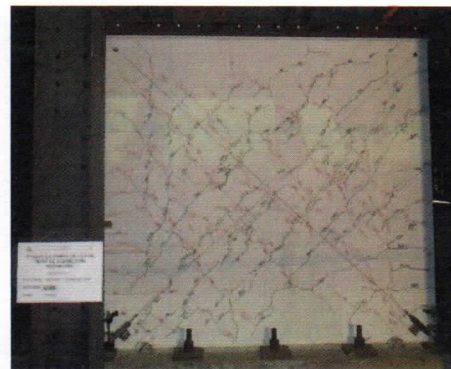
Grietas semi verticales por la zona de confinamiento entre la columna y el muro de albañilería y continuación de grietas diagonales en el muro para una distorsión 1/200 Vista cara Norte.
